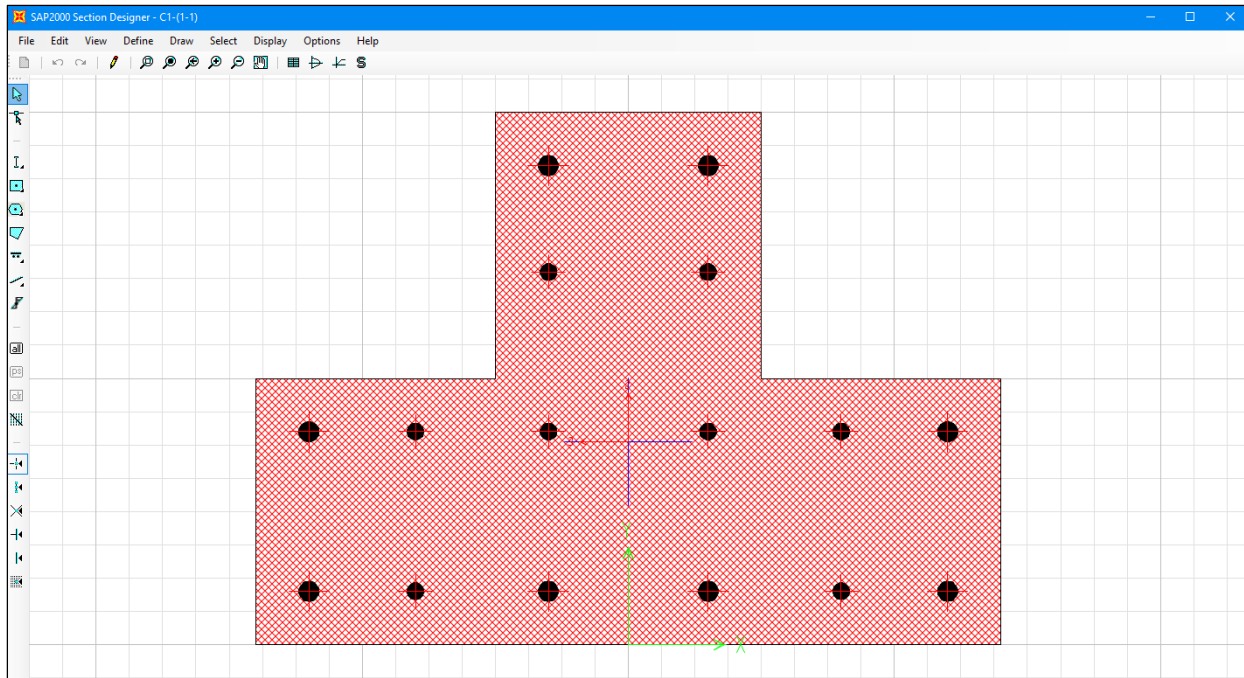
Sección de la columna Tipo C-01 en Section Designer
